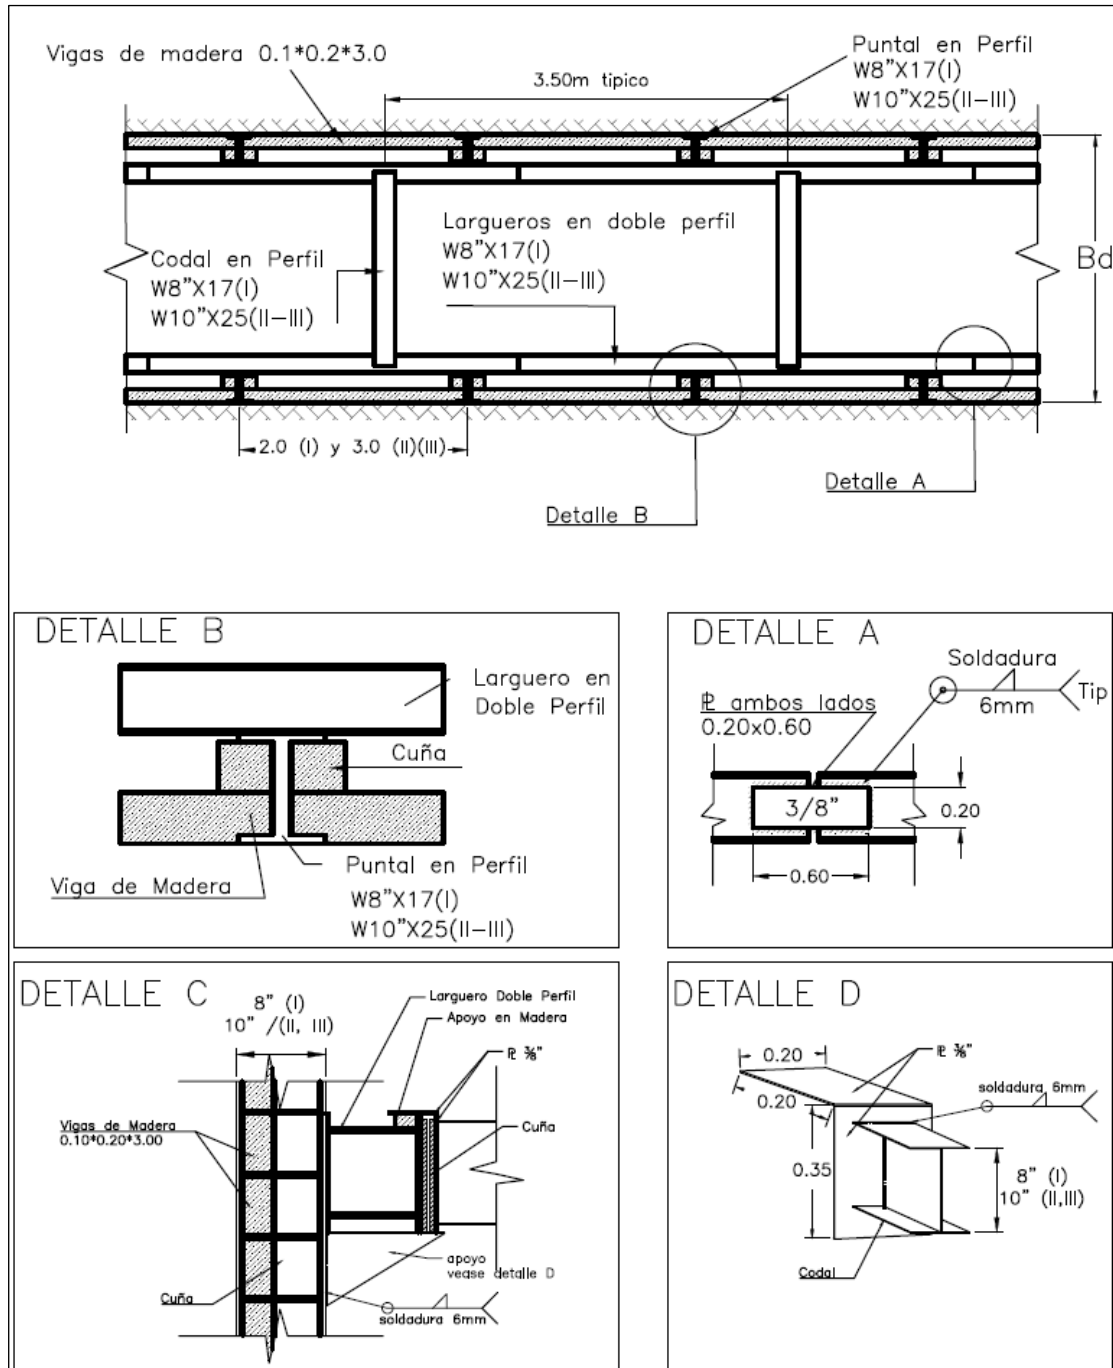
Planta y detalles de entibado Mixto de madera – perfiles metálicos - Modificado de NS-072 de EAAB.
